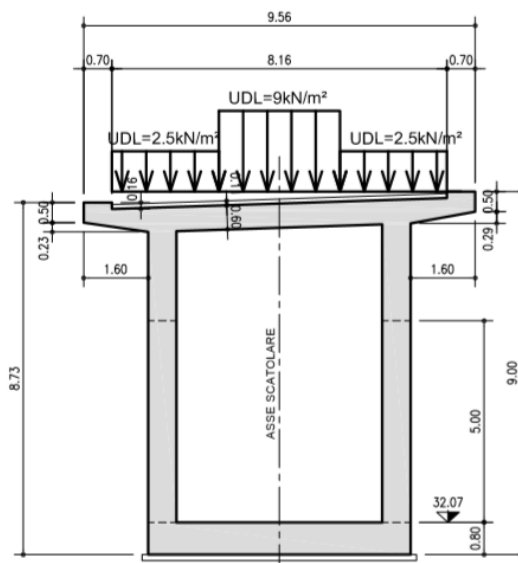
disposizione trasversale dei carichi tandem (4)
